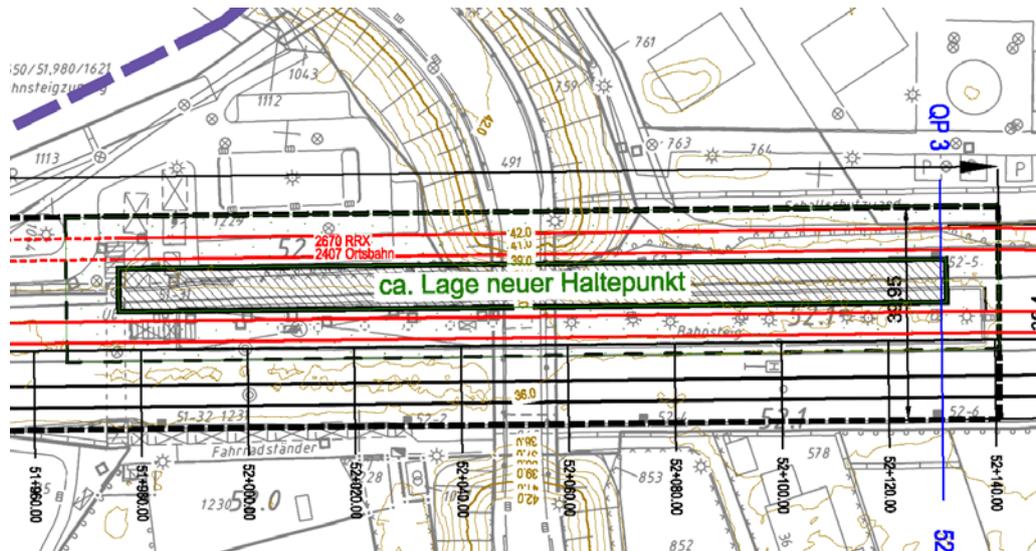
Variante „Einhausung“, Haltepunkt Angermund, Lageplan [1]
